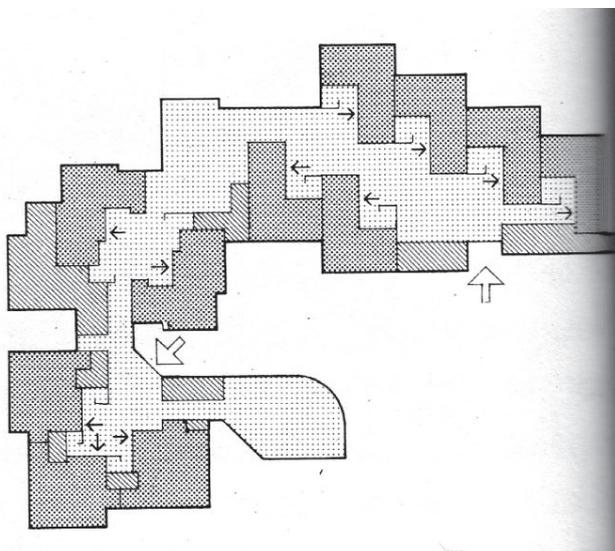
Planta esquemática do pavimento térreo de Delft demonstrando a relação do hall/corredor com as salas.
